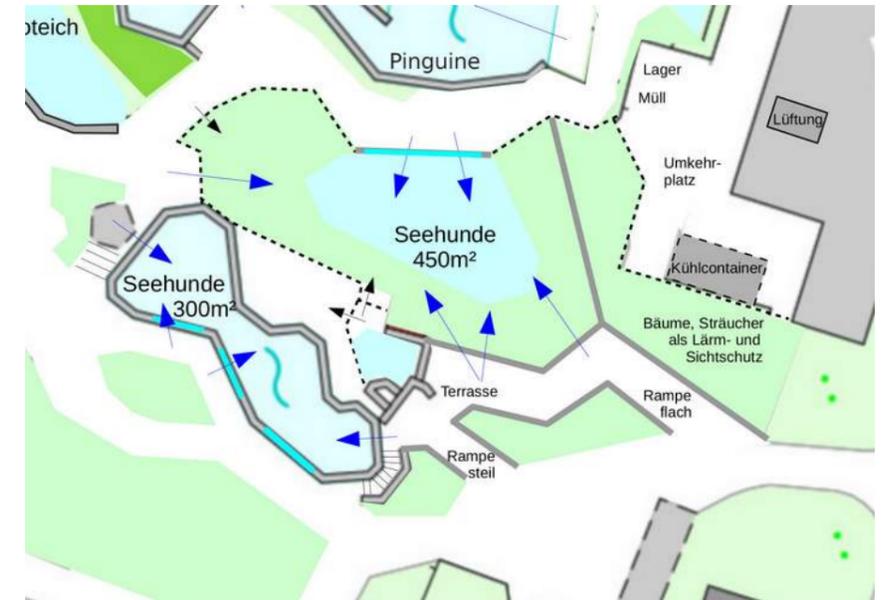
Erweiterung der Seehundanlage mit Unter- und Überwasserblick und barrierefreier Rampe zur Terrasse
